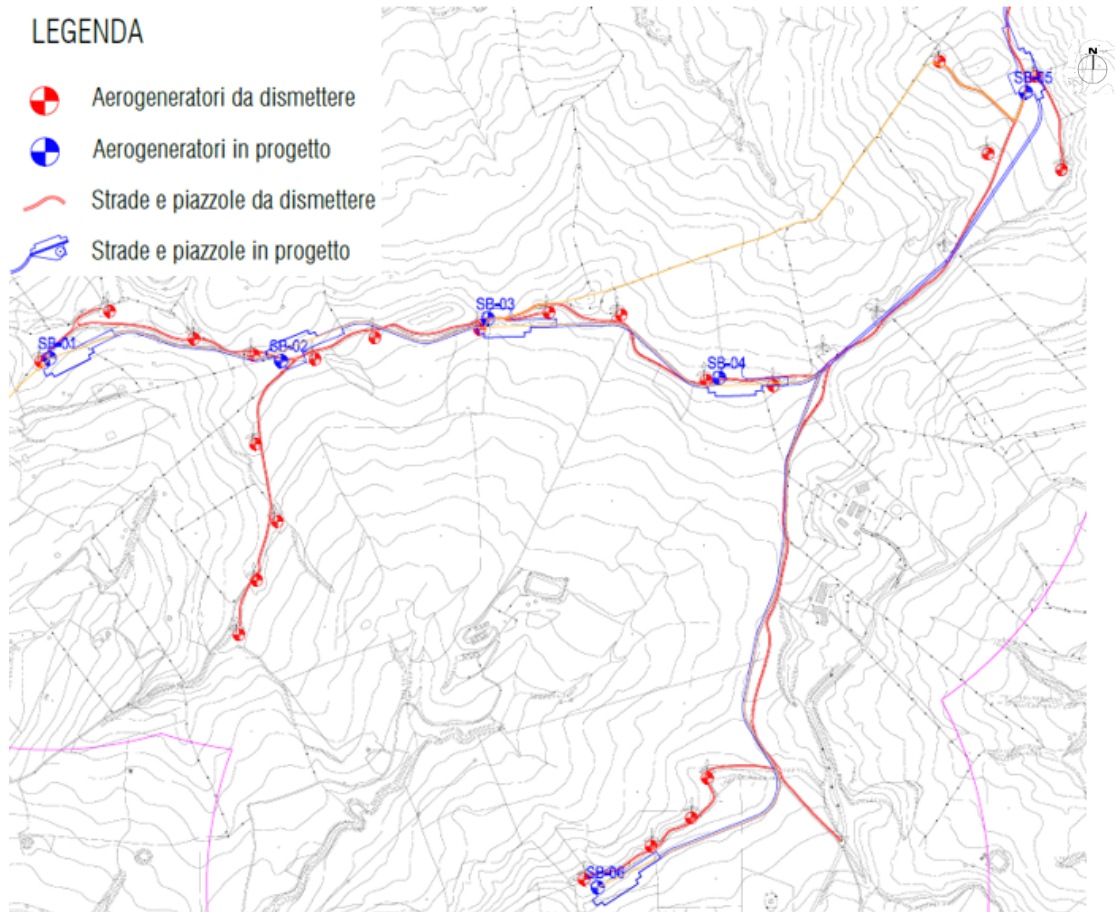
Layout di raffronto tra stato di fatto e stato di progetto
